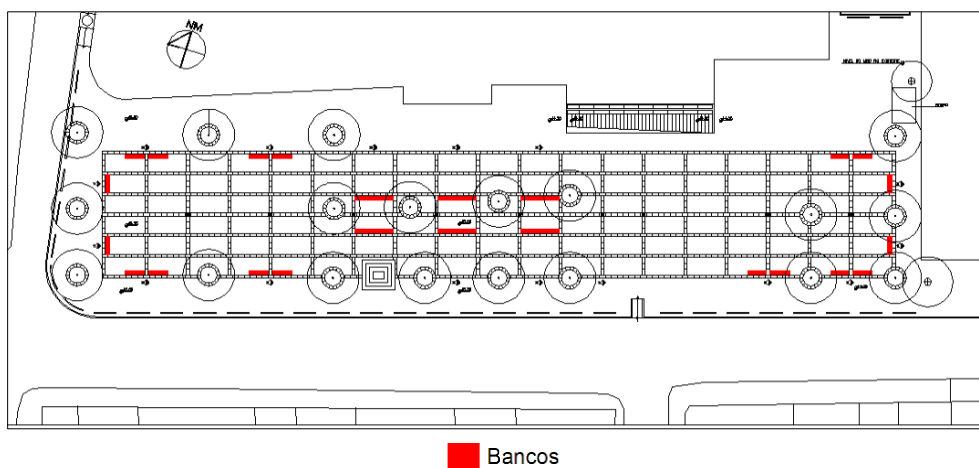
Planta da implantação dos bancos na Praça Dom Adauto
